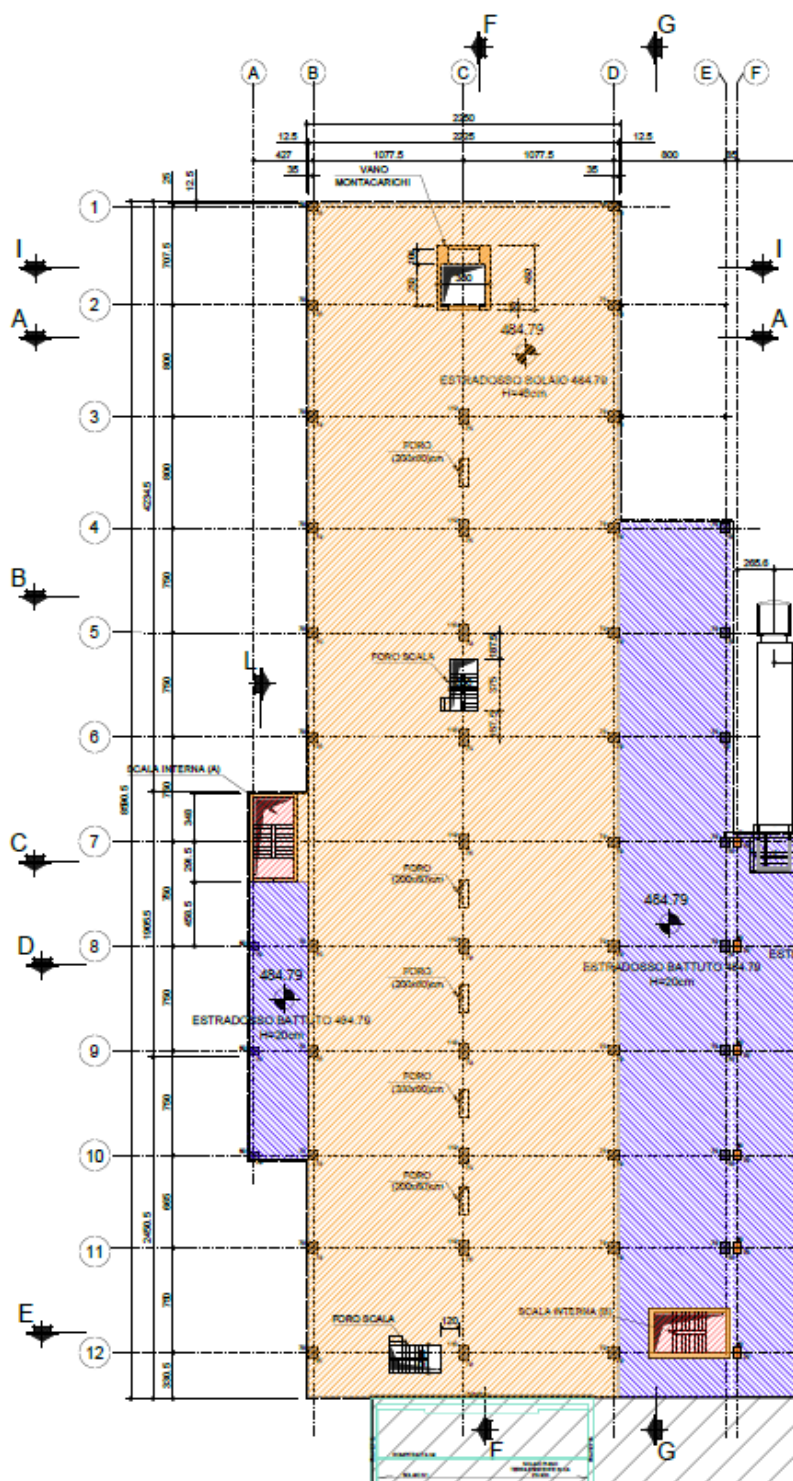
Planimetria piano P0 – Fabbricato Ex. Piemonte
